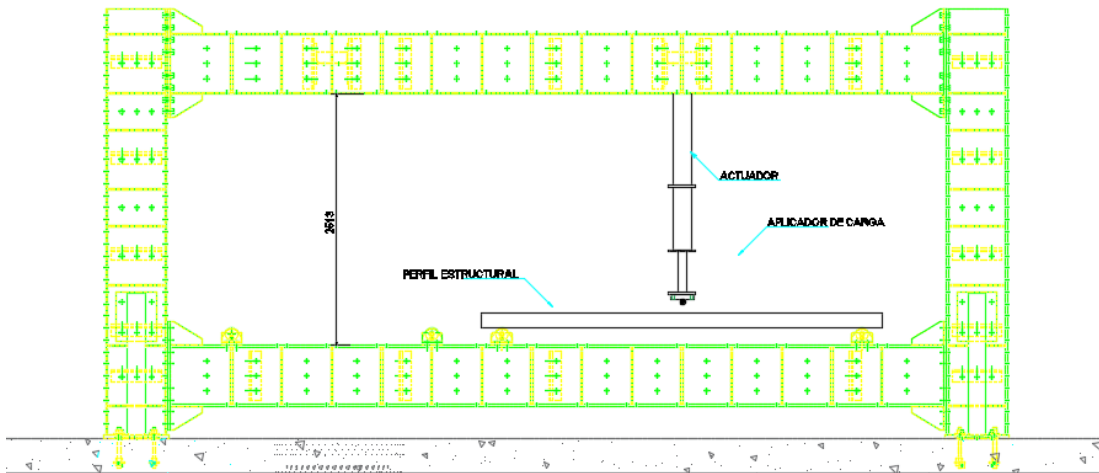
Plano de montaje de actuador para ensayo a flexión PTE– Plano de pórtico tomado de Estahl Ingeniería con modificaciones propias
